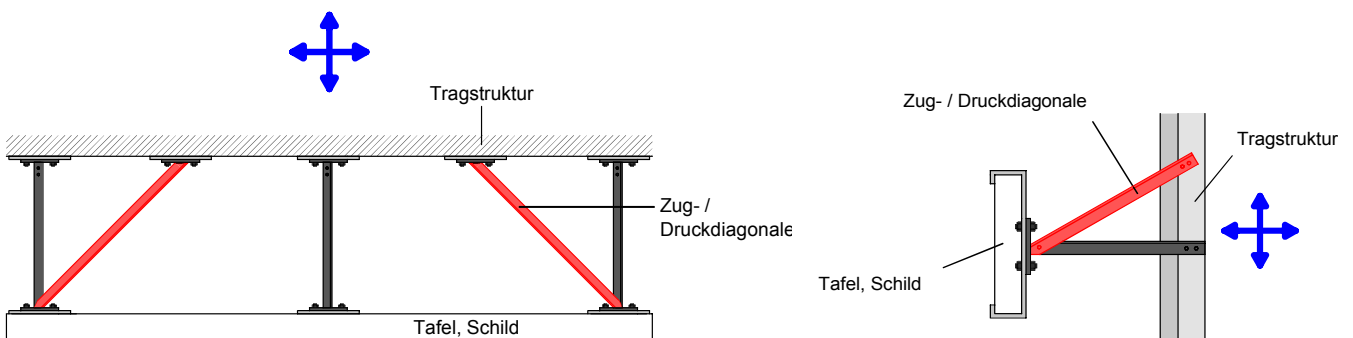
> Massnahmen bei auskragenden Konstruktionen (Darstellung im Grundriss und Schnitt)
